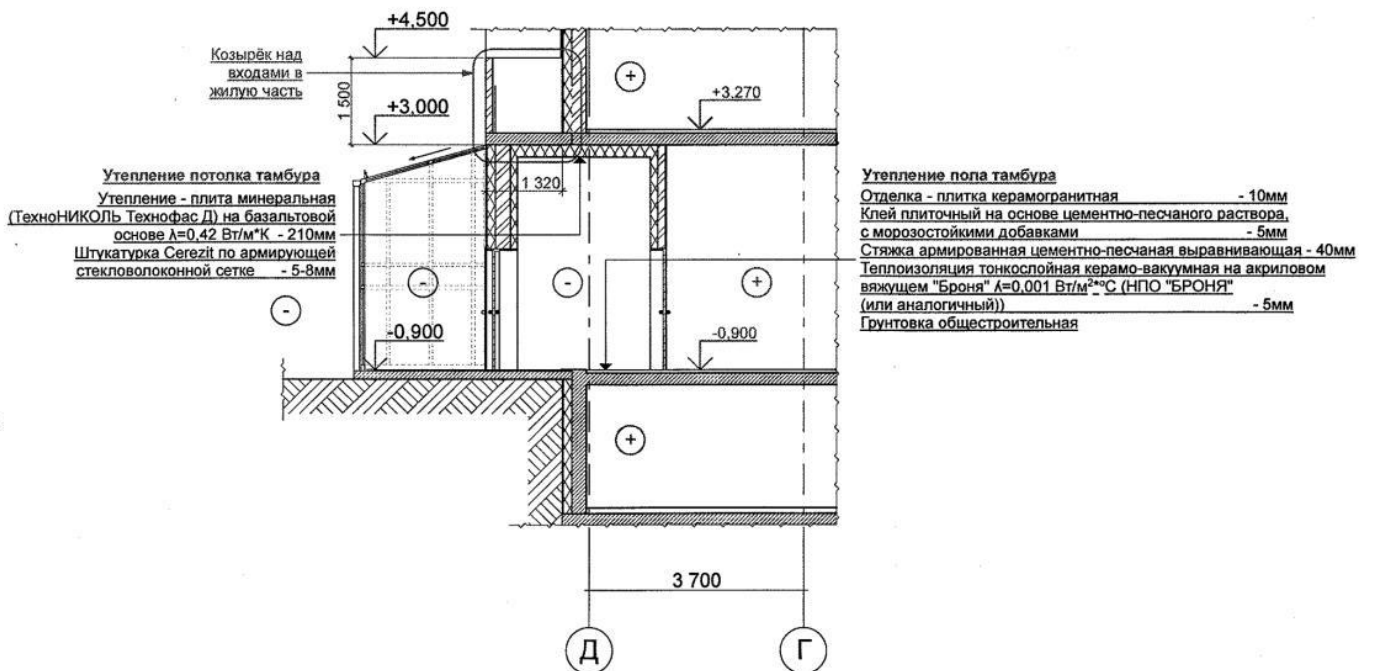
Конструктивные решения жилых зданий из монолитного железобетона
